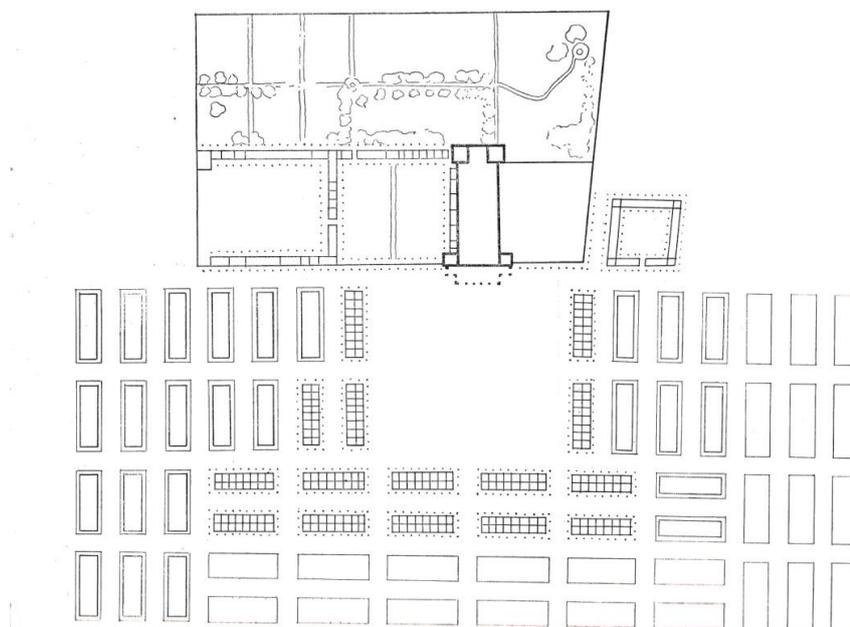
Planta reconstrução do povo de São Miguel Arcanjo (Lucas Mayerhofer).
